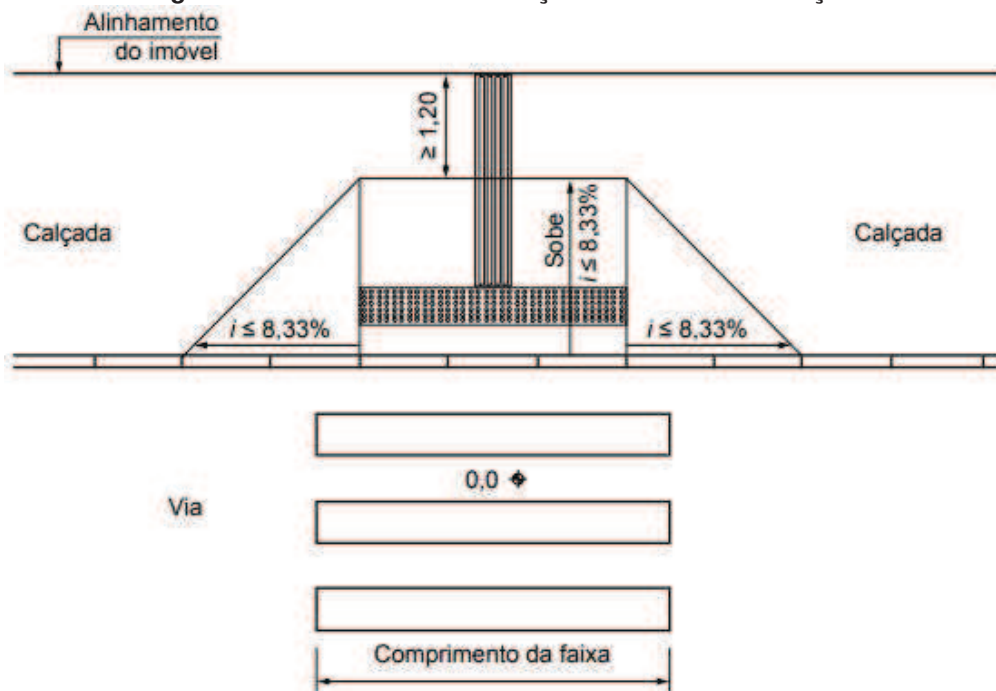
Modelo de rebaixamento de calçada externa a edificação.
